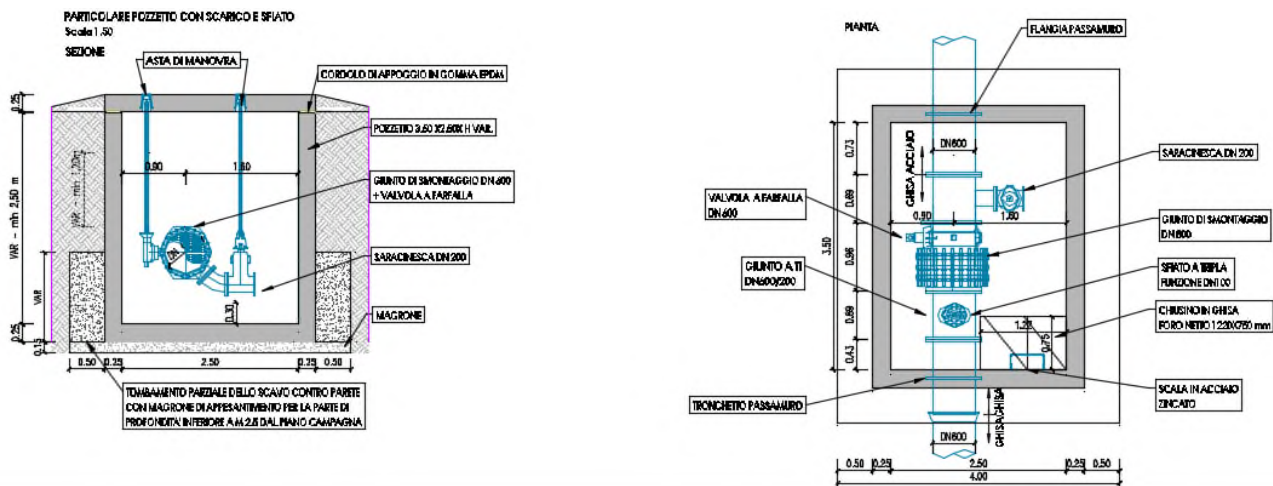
Pozzetto con sfiato e scarico – Sezione e Pianta
